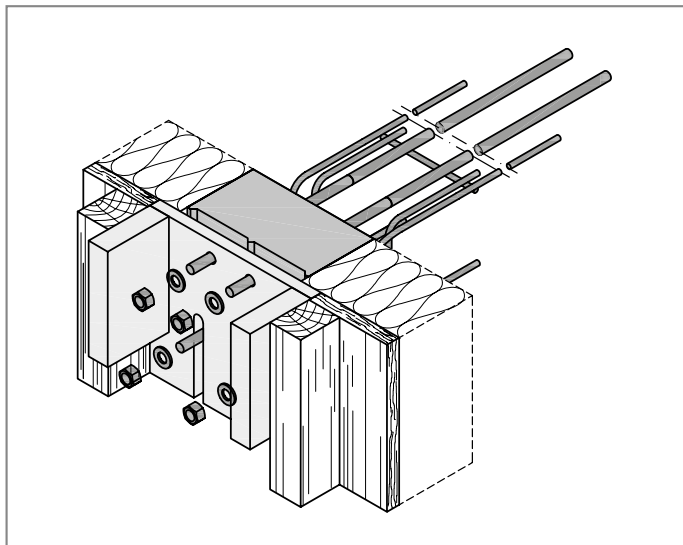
Schöck Isokorb® XT Typ SK: Einbauhilfe umgekehrt eingebaut, um bei monolithischer Wand die lückenlose Deckenranddämmung zu ermöglichen
